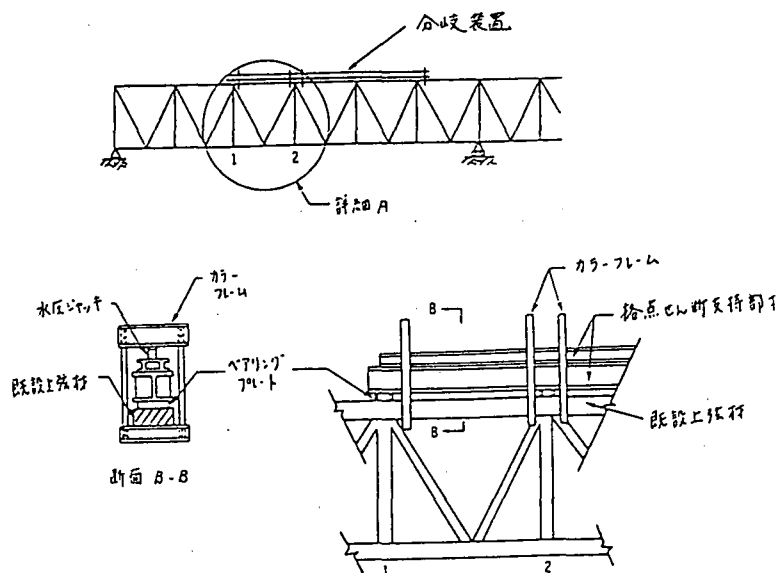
補強時の既存トラス部材の断面力緩和に使用された装置
